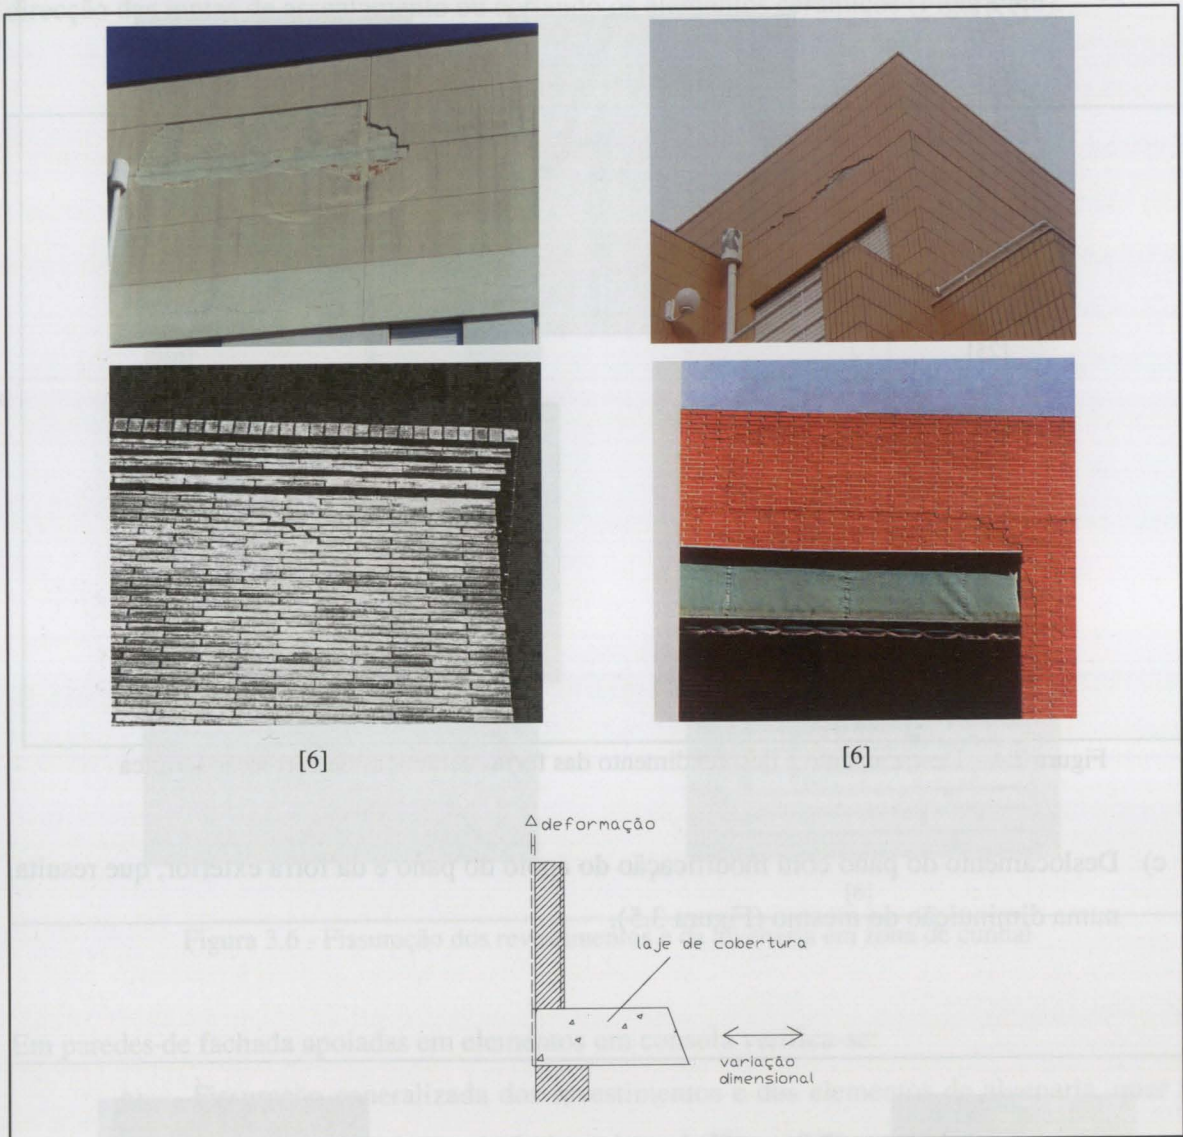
Fissuração horizontal e desprendimento do revestimento junto à laje de cobertura
